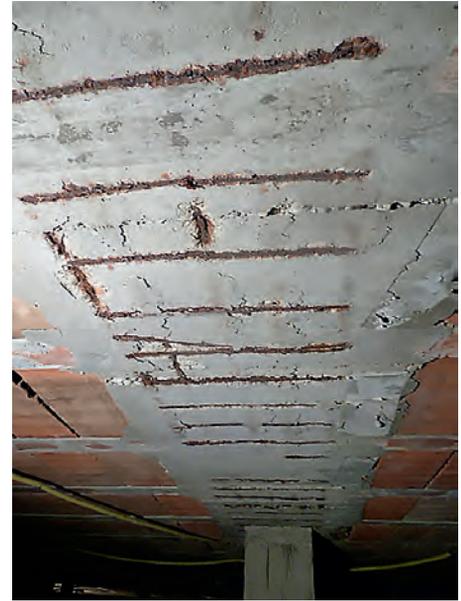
oxidación/corrosión del armado inferior de viga de forjado. Deficiente recubrimiento del armado.
